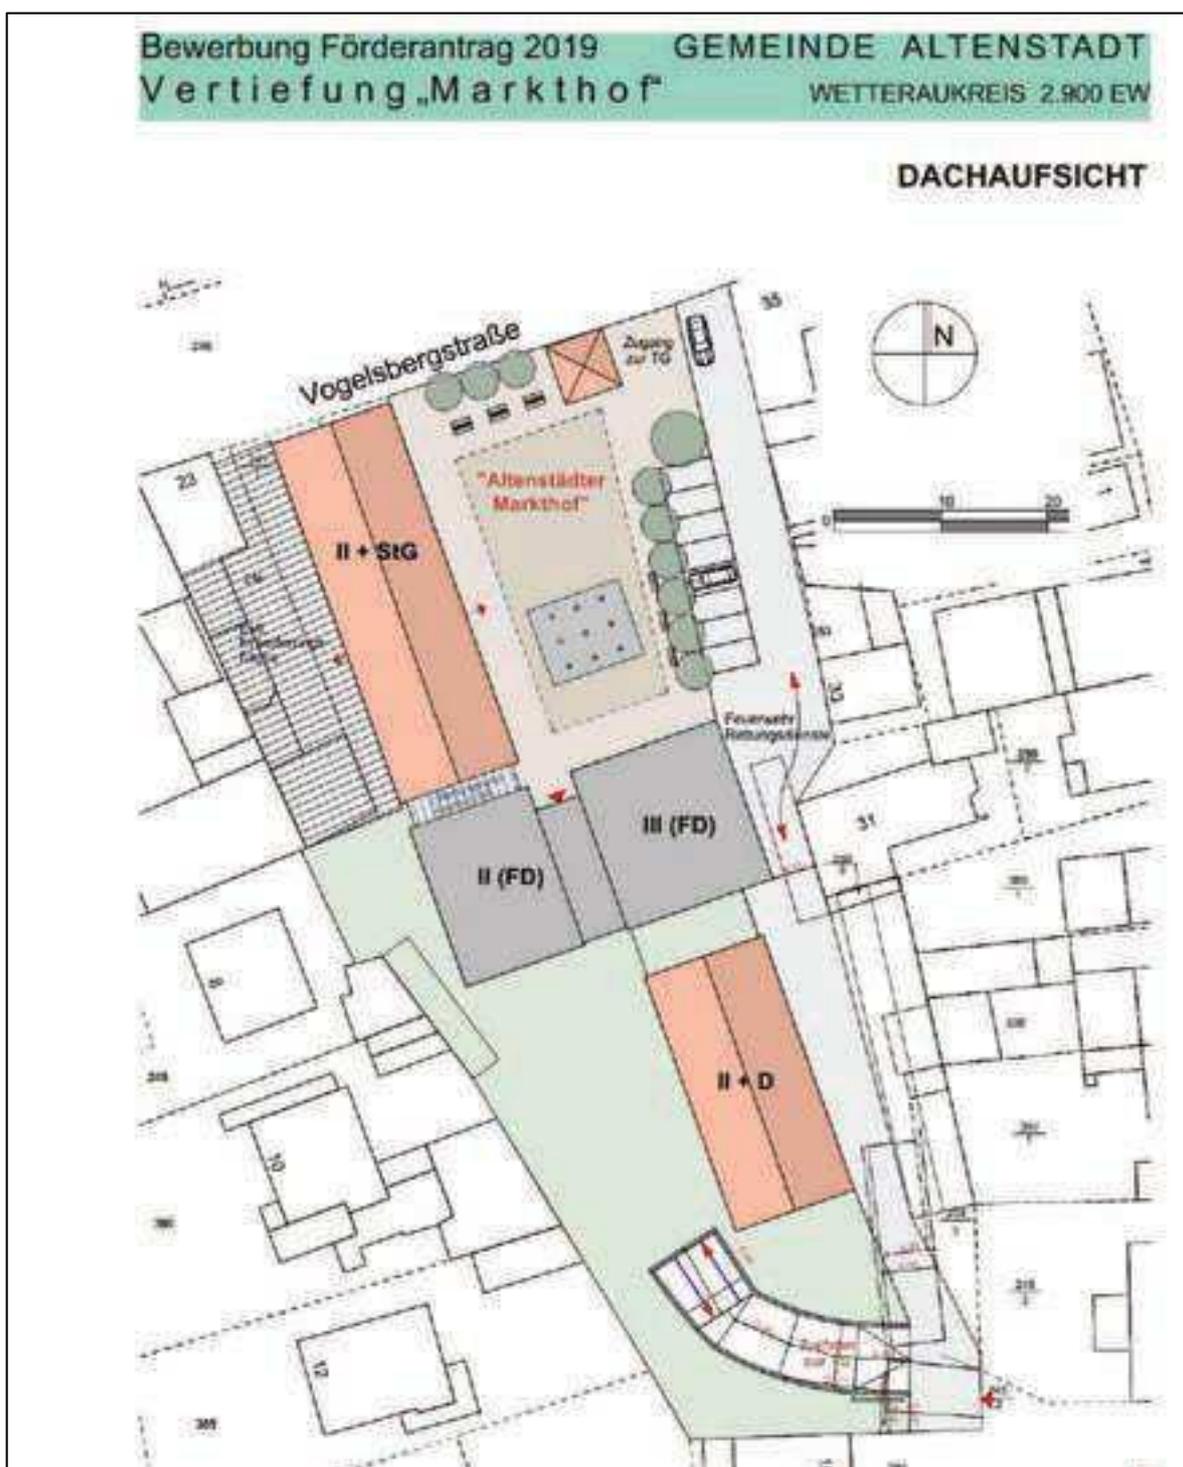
Planungsskizze Eberhardtgelände Dachaufsicht, Quelle: Studie „Vertiefung Markthof“ 2019
